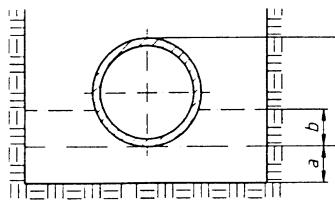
Rohrbettungen nach DIN EN 1610, Ziffer 7.2
